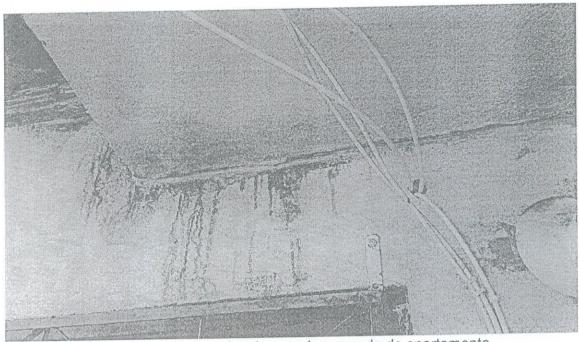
Fissura entre laje da caixa de escada e parede de apartamento
